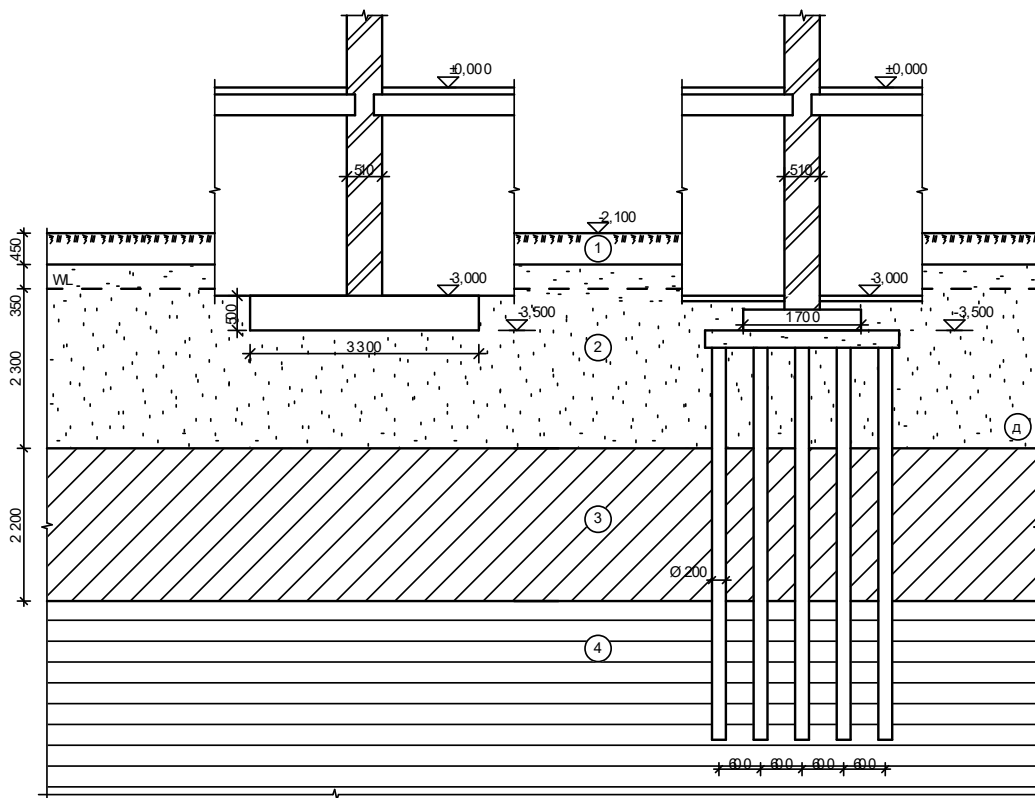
Розміщення у ґрунті фундаментів під середню поперечну стіну у двох розглянутих варіантах
